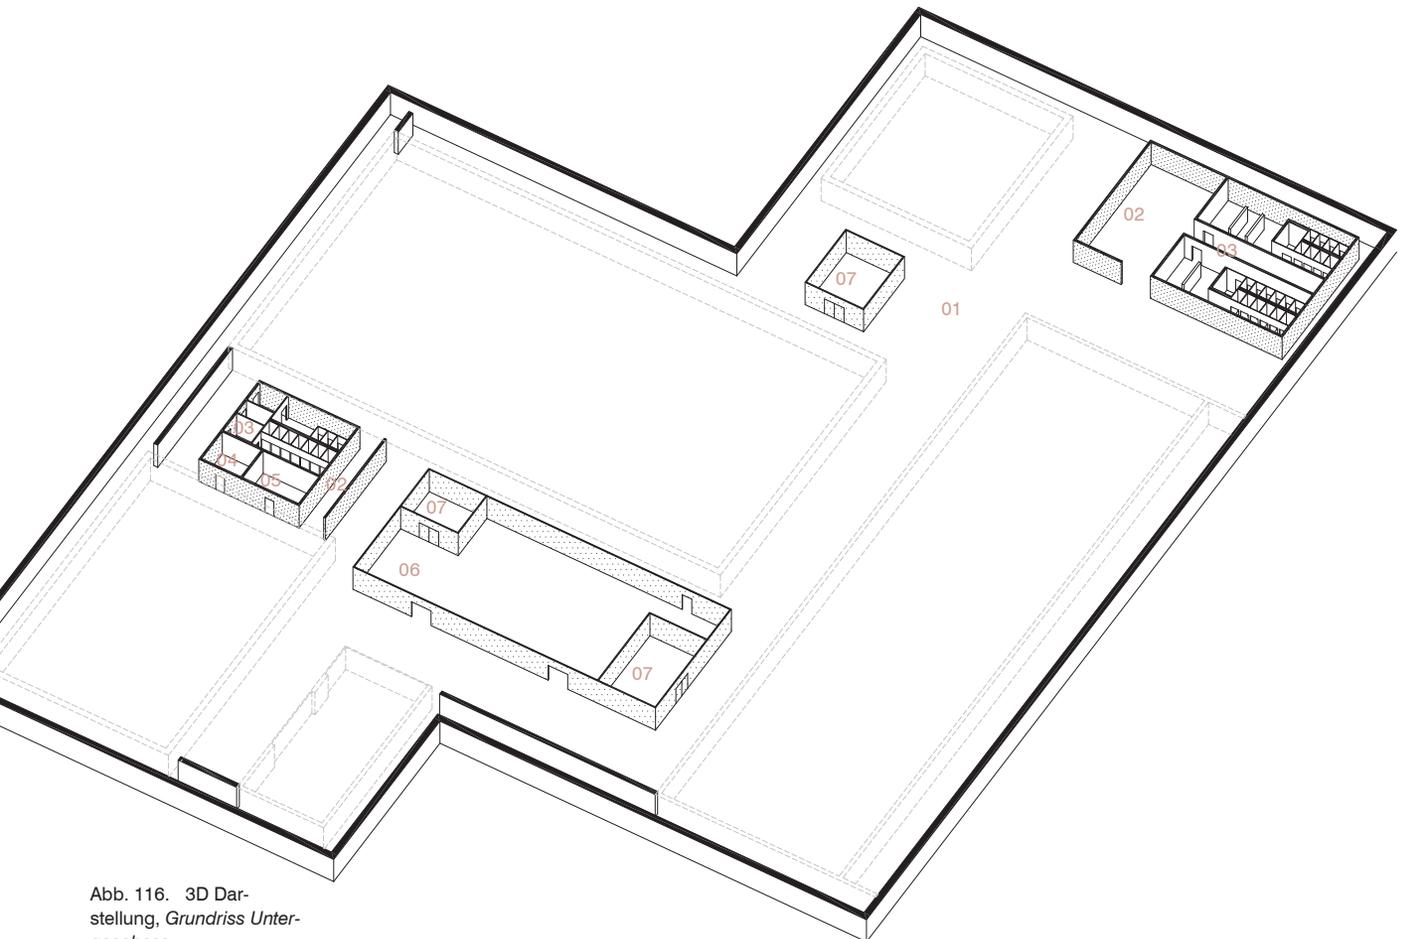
3D Darstellung, Grundriss Untergeschoss
